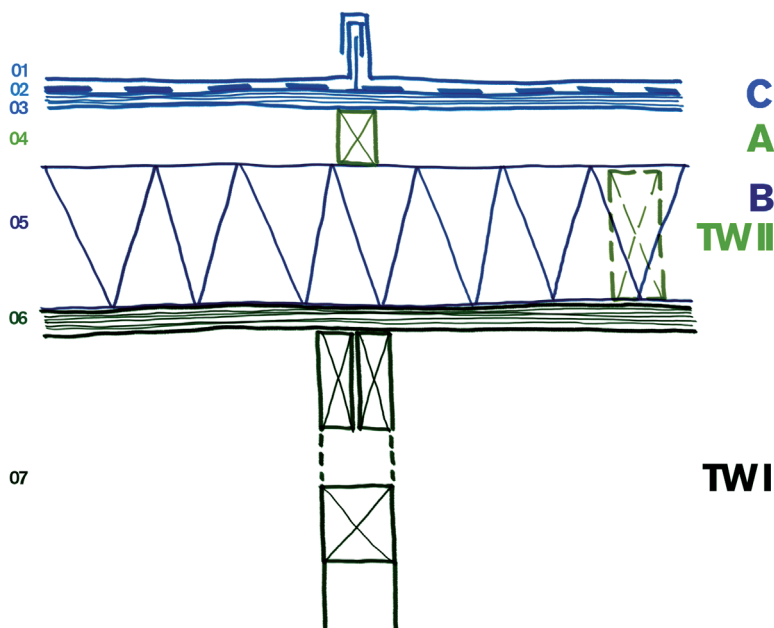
Skizzenhafte Darstellung des Dachaufbaus, Fallstudie A (Holzbau)
